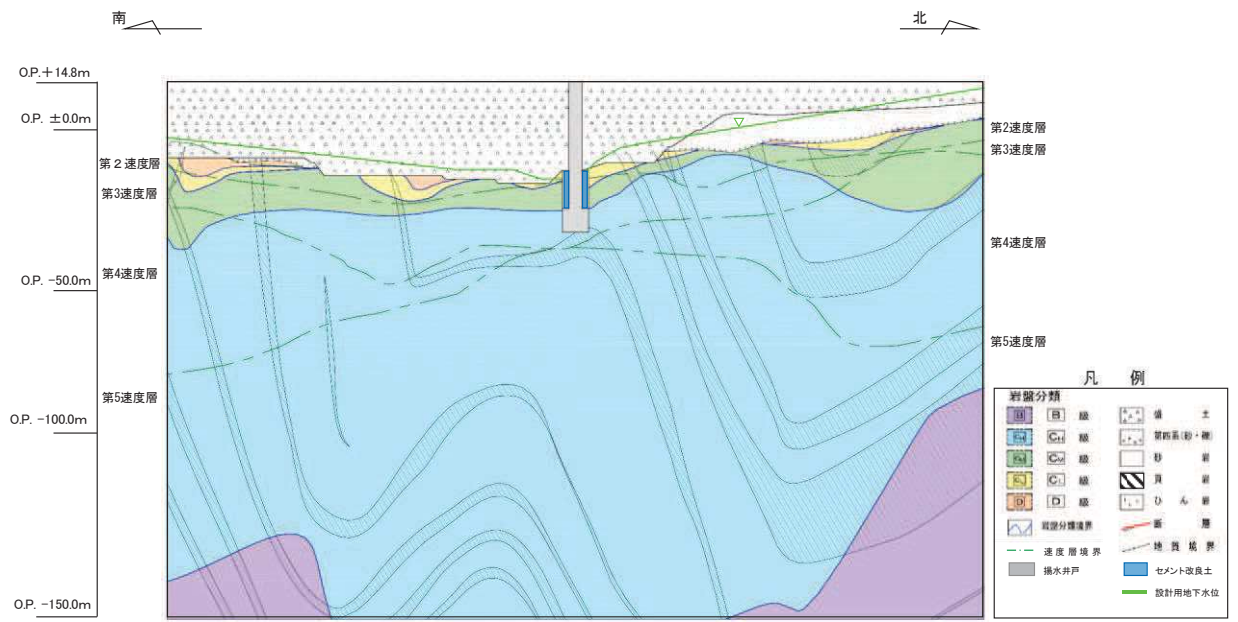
(3) No.3 揚水井戸 評価対象断面図 (C-C' 断面)
